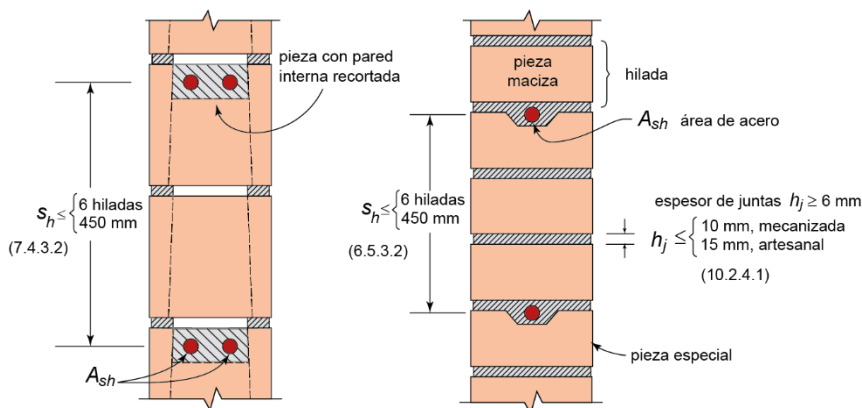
Refuerzo horizontal en piezas especiales
